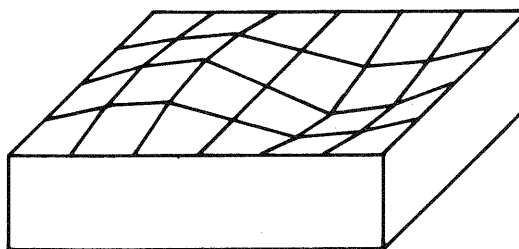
Planiertes Gelände nach einem Massenausgleich
